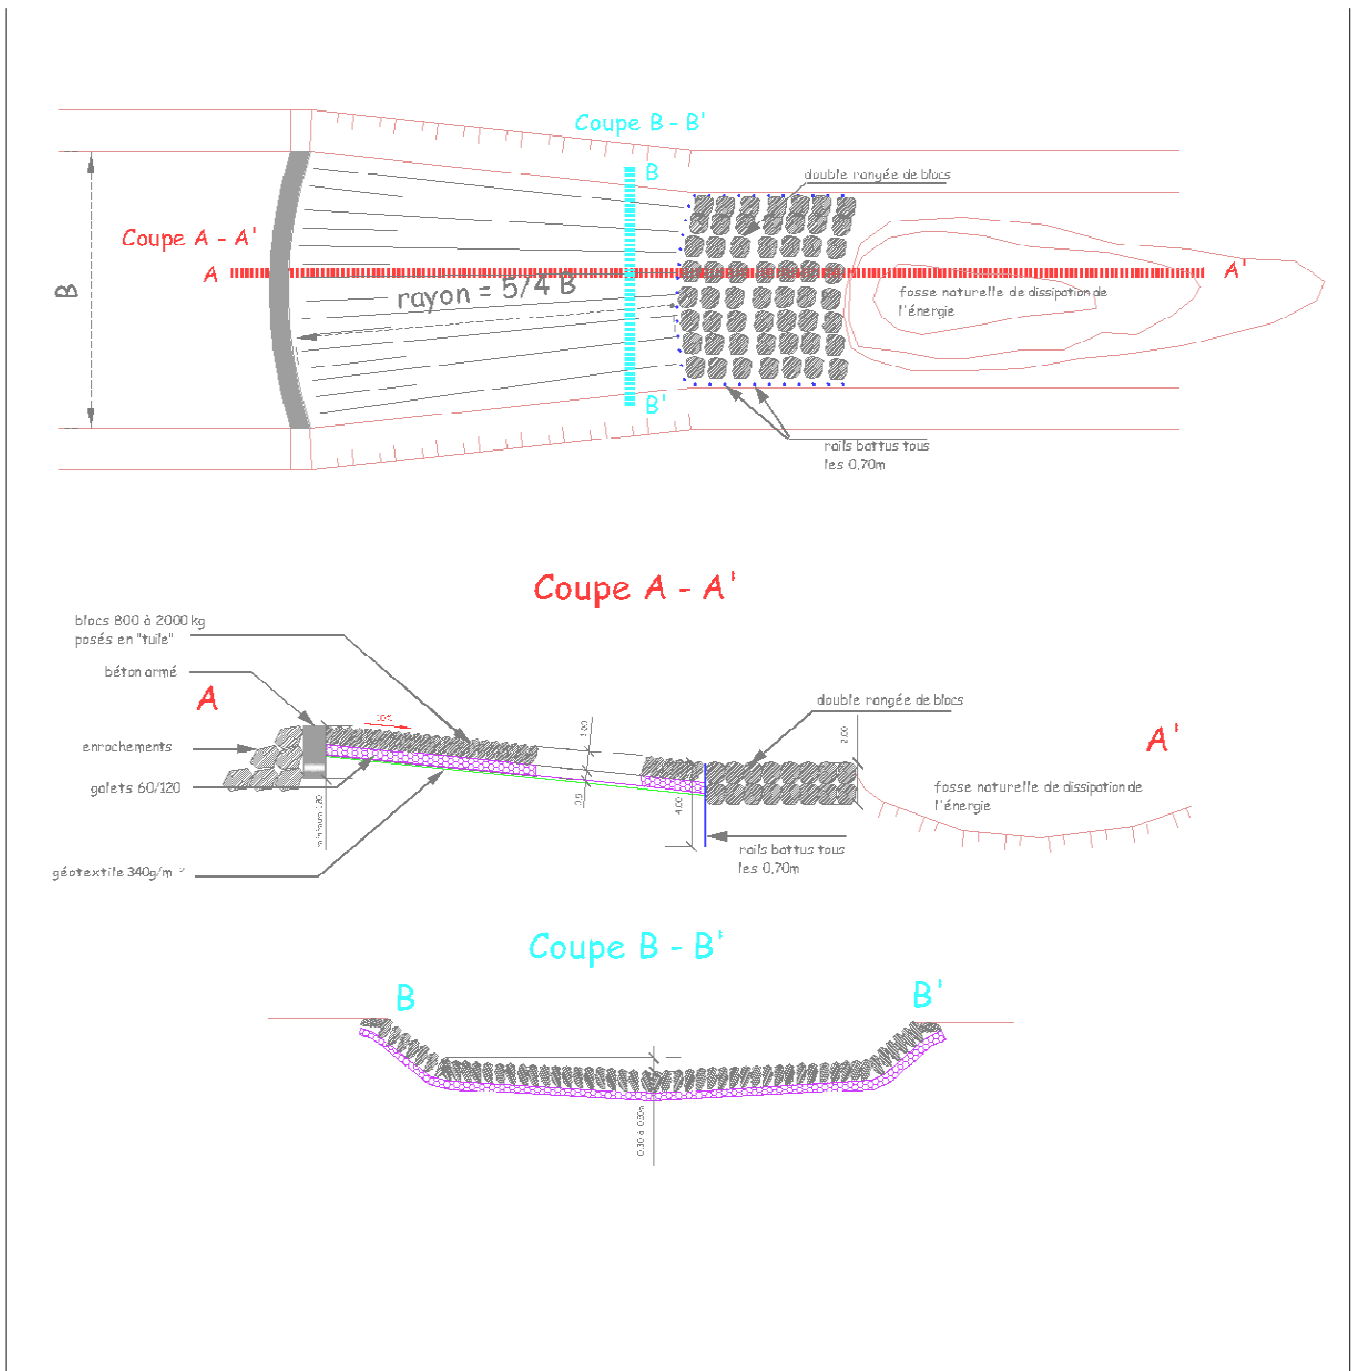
Schéma de principe d'une rampe en enrochement sec
